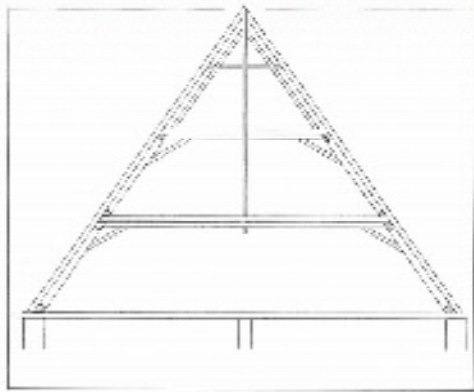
Dreistöckiges Kehlbalckendach mit Hängewerk
